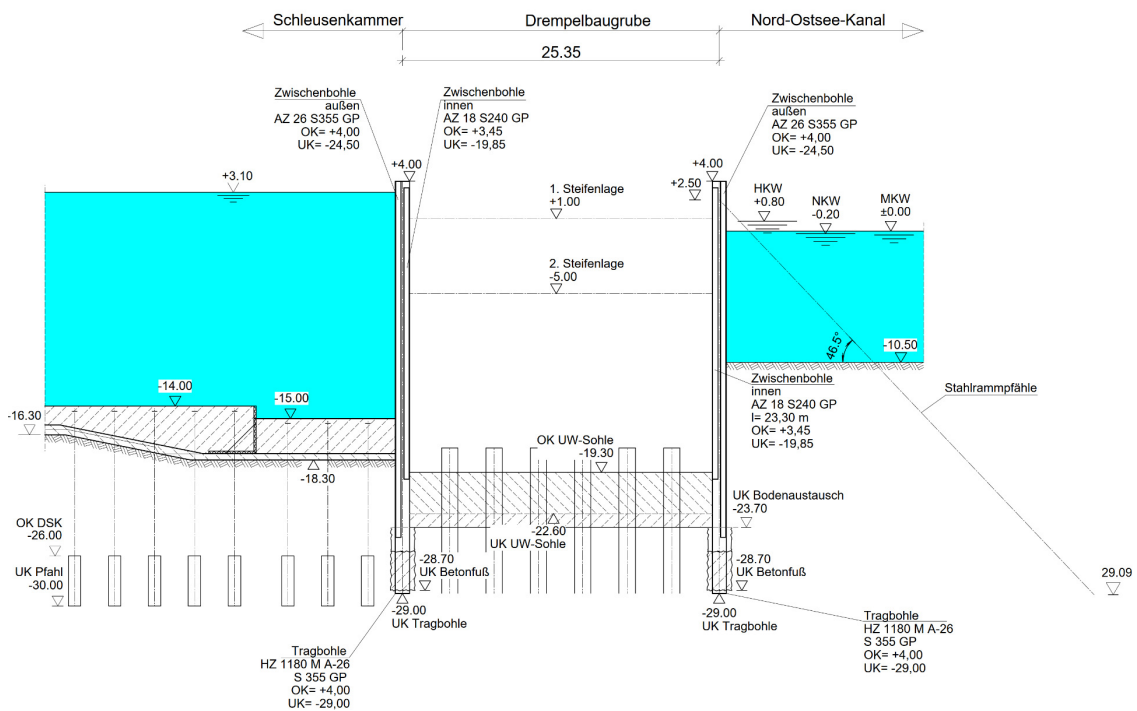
Schnitt 2-2, Drempelbaugrube Binnenhaupt
